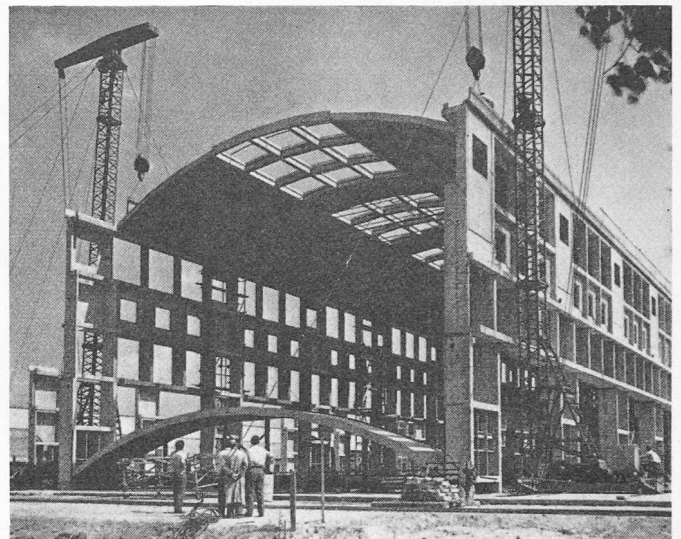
Kurze Tonnenschalen einer Werkhalle in Budapest
